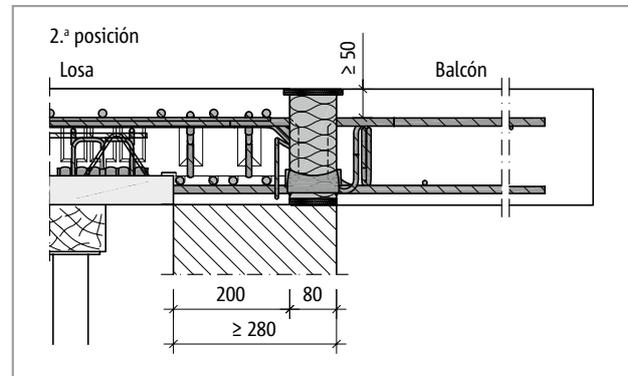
Schöck Isokorb® T tipo C: Placa prefabricada con apoyo periférico con muro aislante (sección T tipo C-CV50-2.ª posición, vista T tipo C-CV35-1.ª posición)
